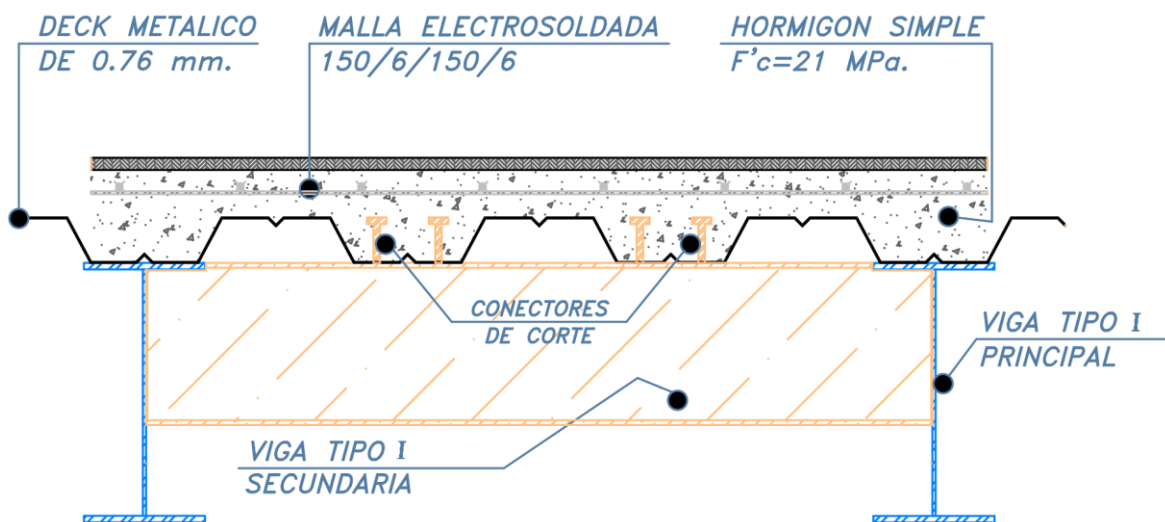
Sección de vigas principales, viga secundaria y losa deck.
